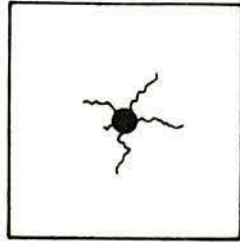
Fissuração observada nos CP com barras de ϕ 16.0 e 20.0 mm.
